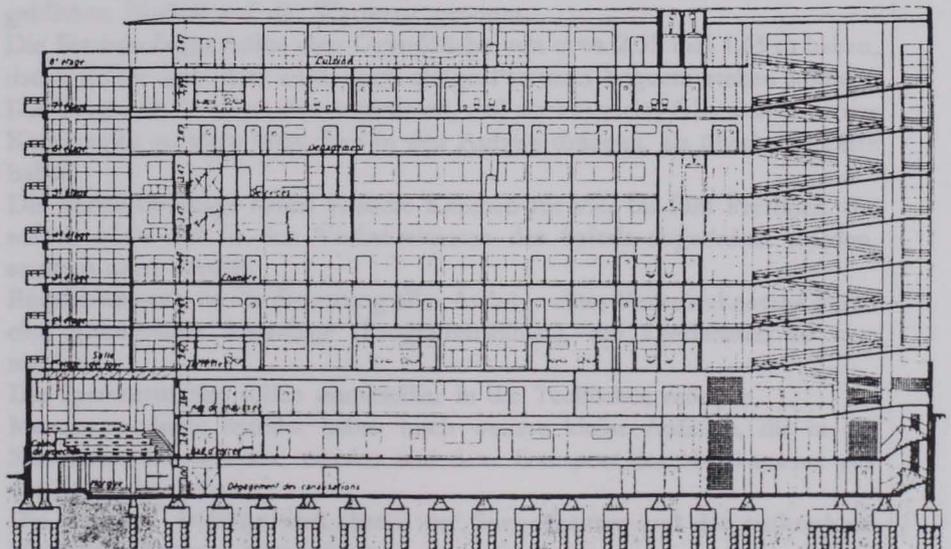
Längsschnitt durch den Hauptflügel und die Spindelrampe im Krebskrankenhause in Brüssel. 120 Betten. Arch. G. Brunfaut und S. Jasinski
